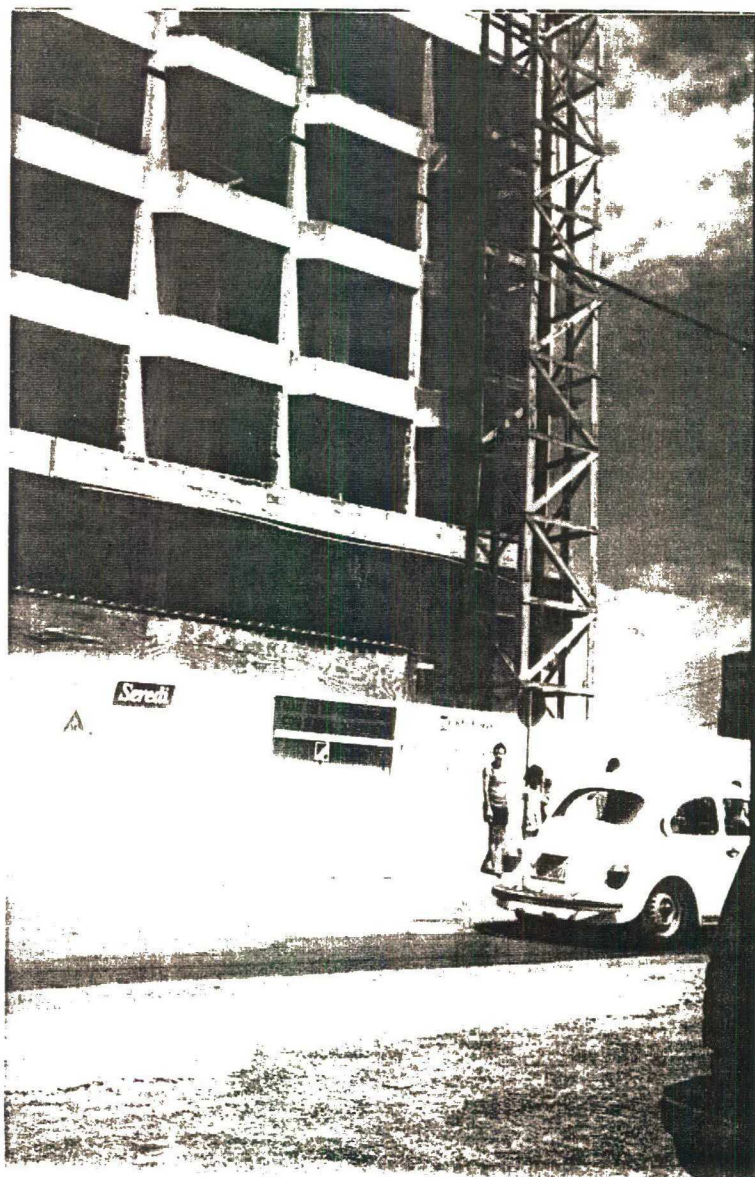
Construção com apoio do FUNGETUR - EMBRATUR
